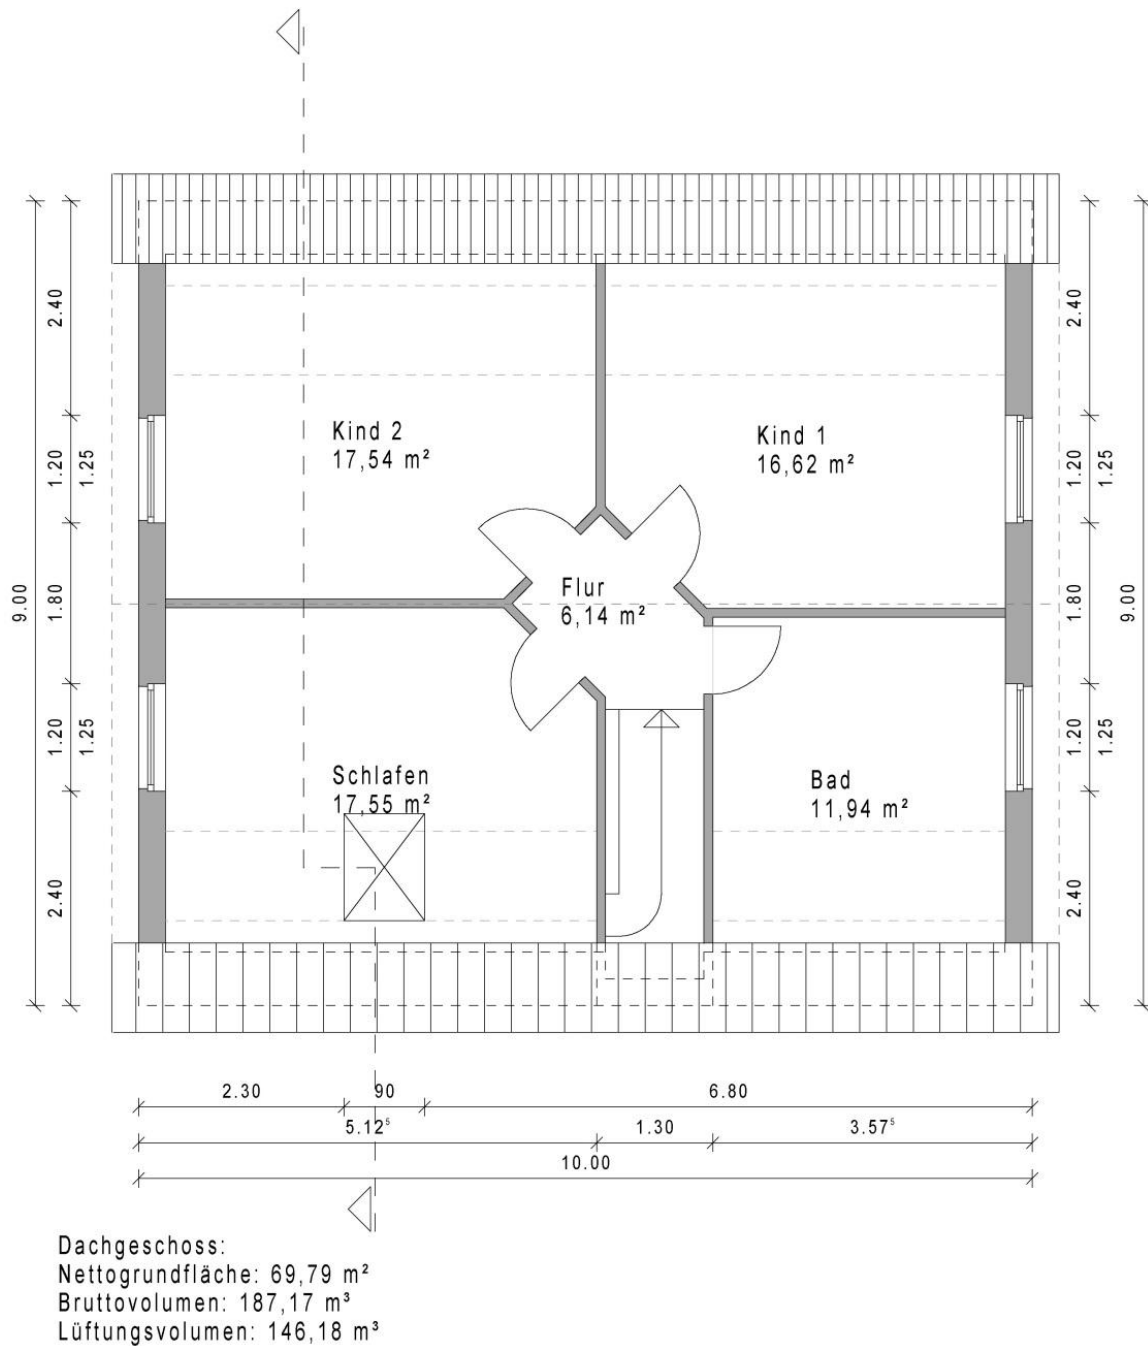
EFH - Grundriss Dachgeschoss
